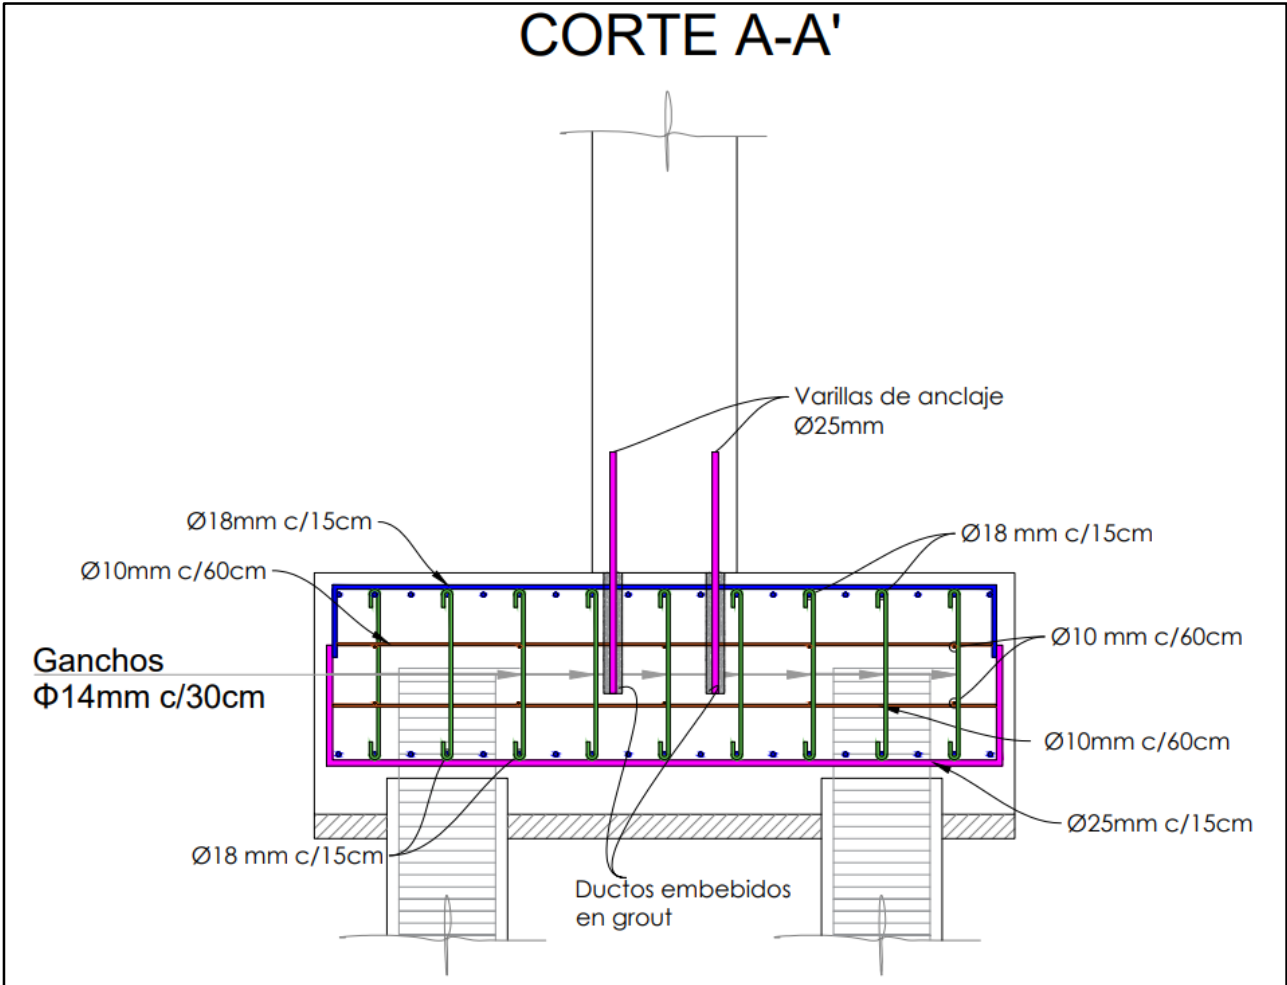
Armado de la zapata en el corte A-A'. Fuente del autor.
